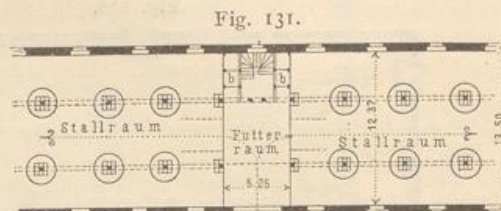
ist der teilweise Grundriss eines in den Umfassungswänden aus Kalksand-Stampfmasse (1 Raumteil Fettkalk und 8 Raumteile Sand) errichteten
